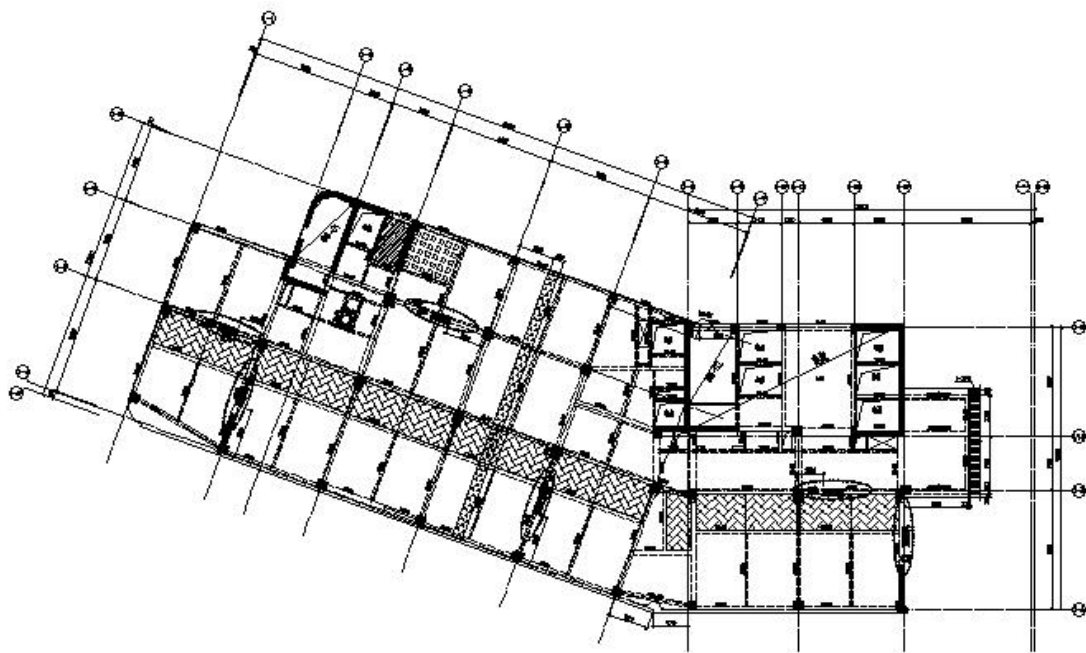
调研楼栋标准层结构平面图（建筑面积约 2600 平方）
